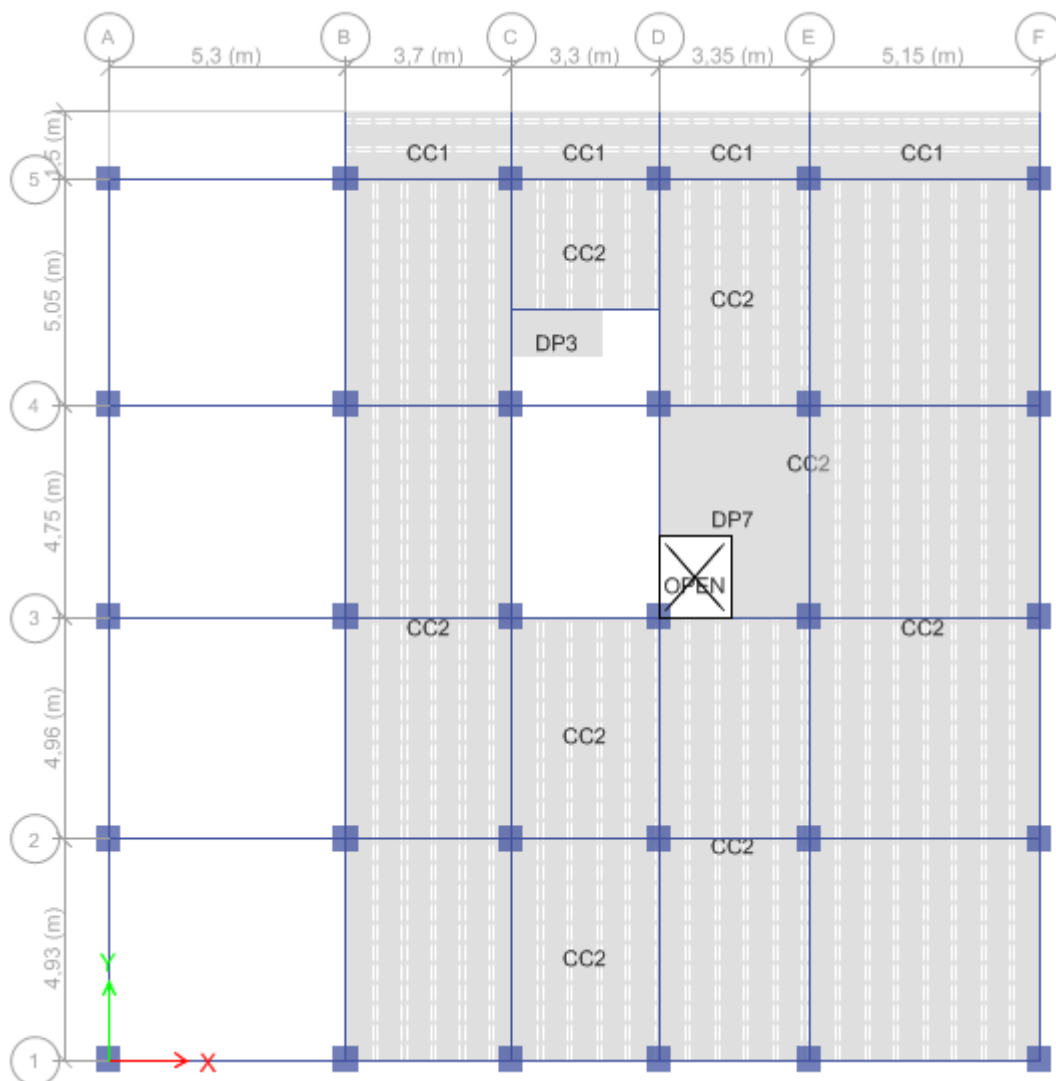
Disposition des poutrelles plancher RDC et entre sol 1
